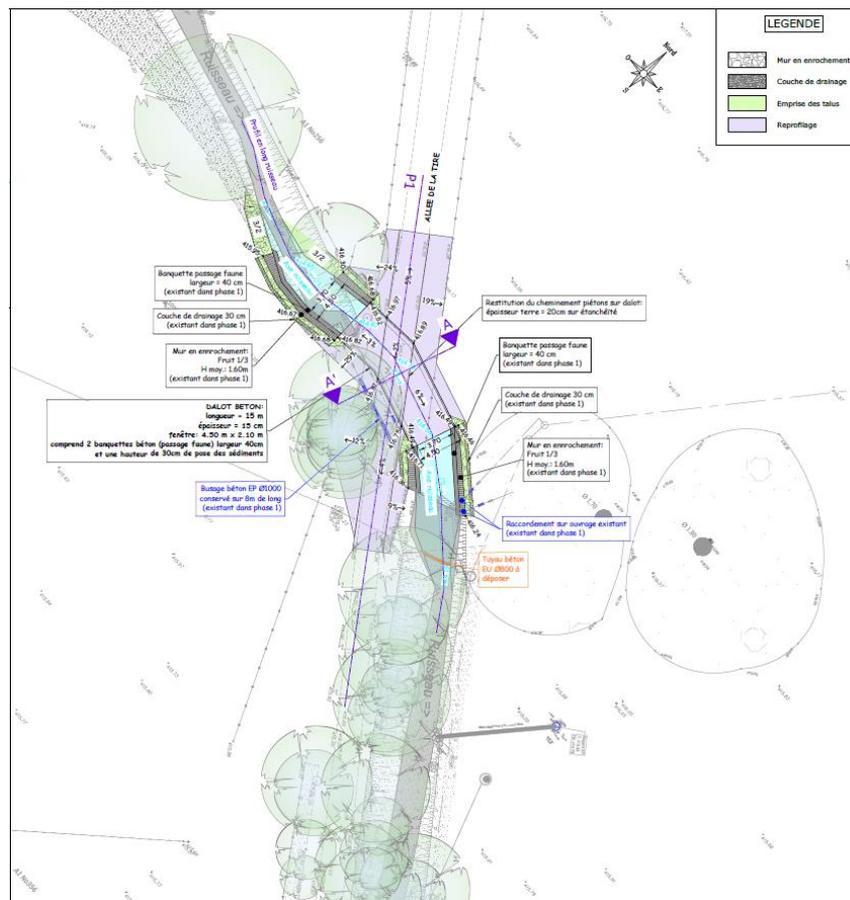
Étape 2 : Installation de l'ouvrage cadre définitif de franchissement du Nant, plan masse, PRO MS11 TLG, ABEST, Octobre 2024
